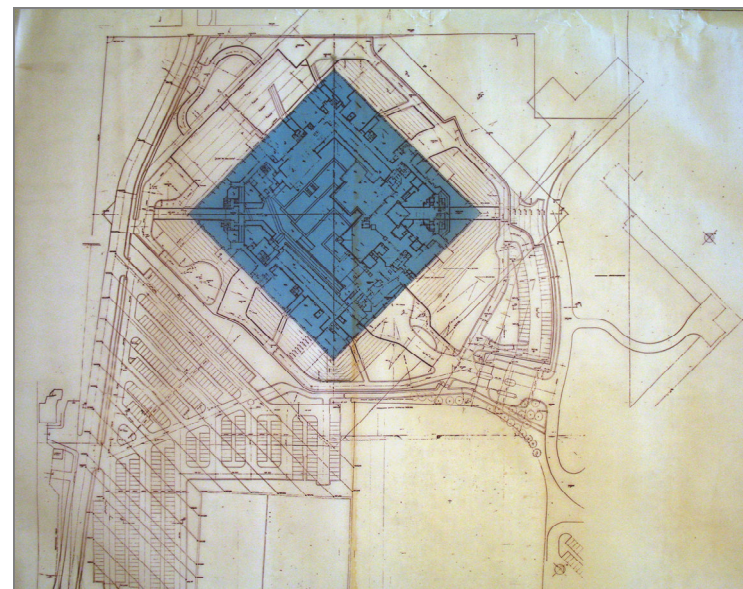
planimetria generale – sistemazione esterna (fonte CSAC – stralcio tav. 103, archivio n. 384-3)
